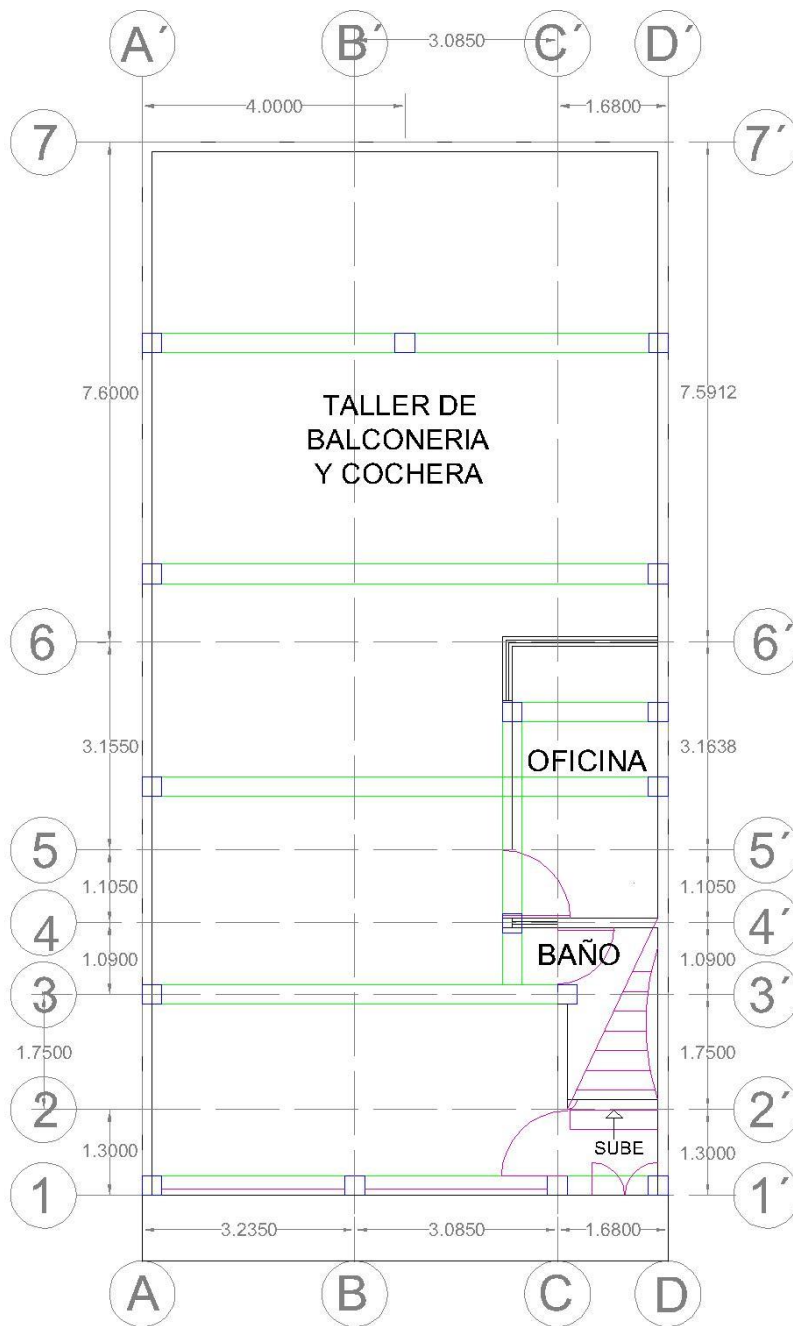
Distribución en planta baja (acotaciones en metros).
